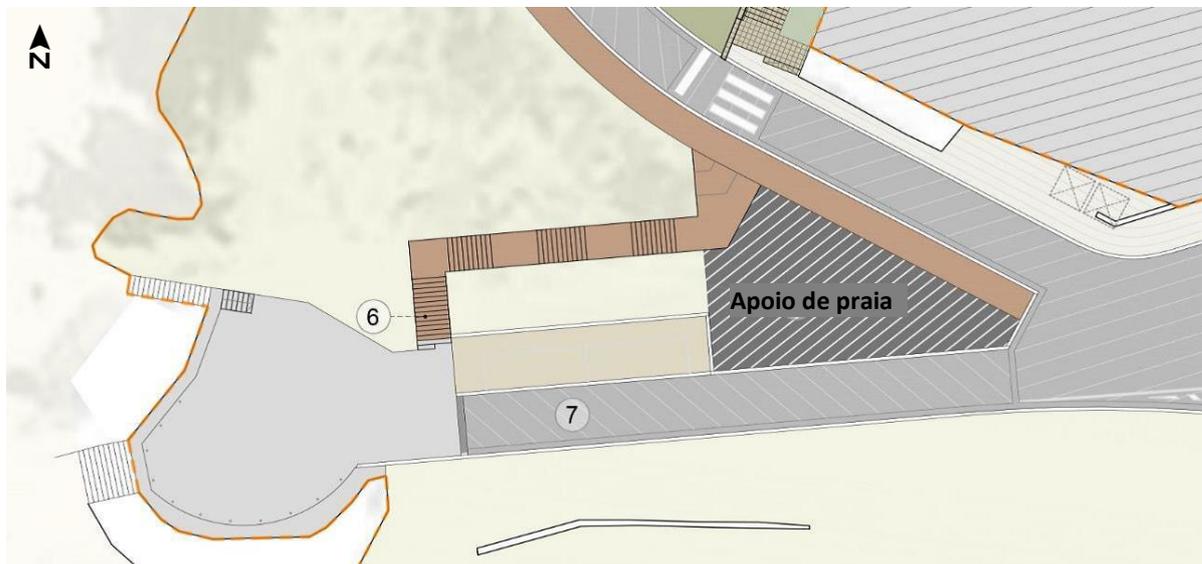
Zambujeira: Proposta para implantação do futuro apoio de praia
